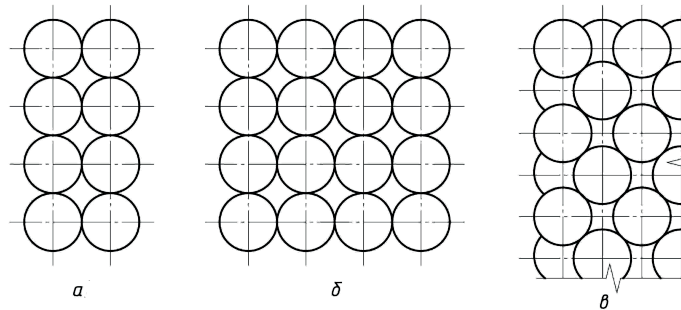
Схеми розташування в плані круглих силосів із монолітного залізобетону:
